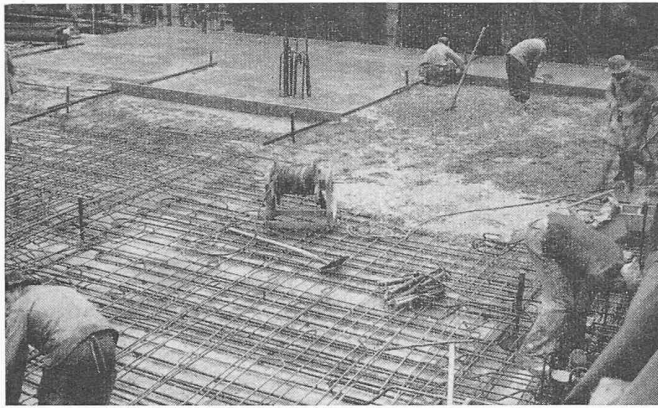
Telephonegebäude Zürich-Selnau aus Plastocrete-Eisenbeton
